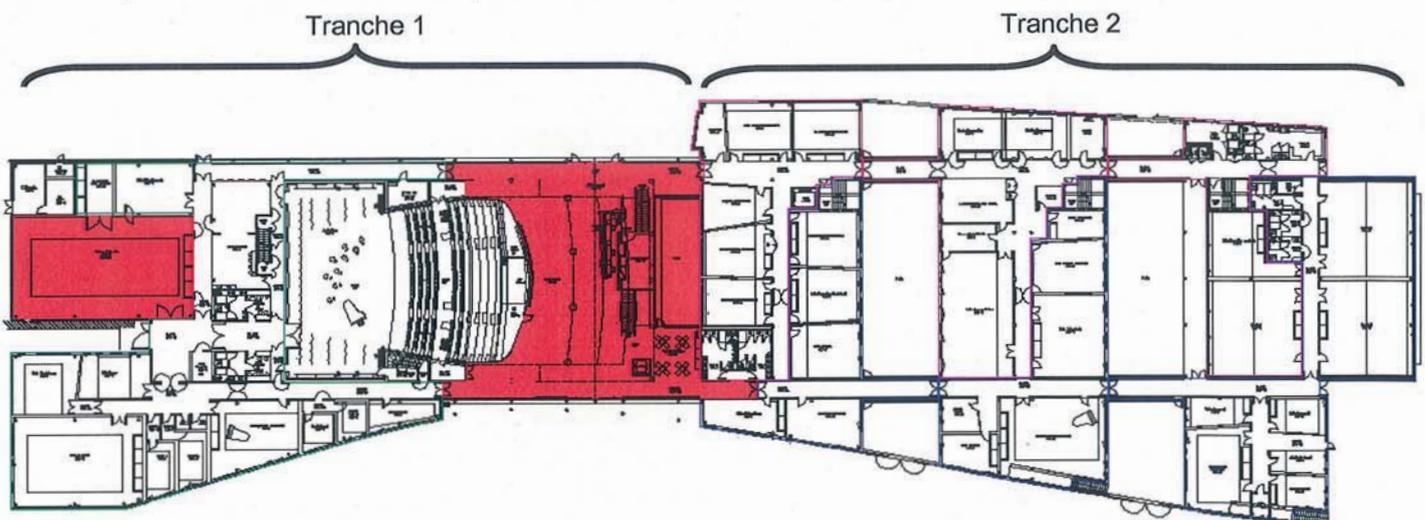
Plan du RDC avec les zones en chauffage seul (en rouge)
